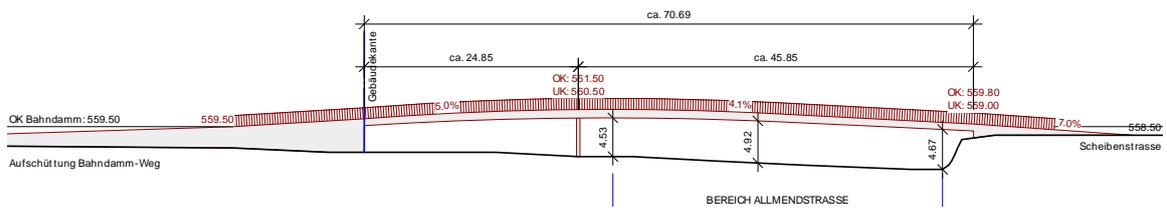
Allmendstrasse Variante 2, Plan genordet, o. Masstab (A3-Plan im Anhang)
